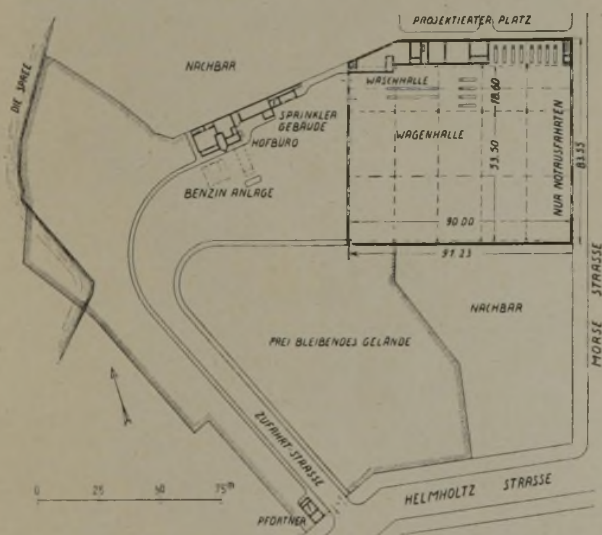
Lageplan des Betriebsbahnhofes an der Helmholtzstraße. (rd. 1 : 3000.)
